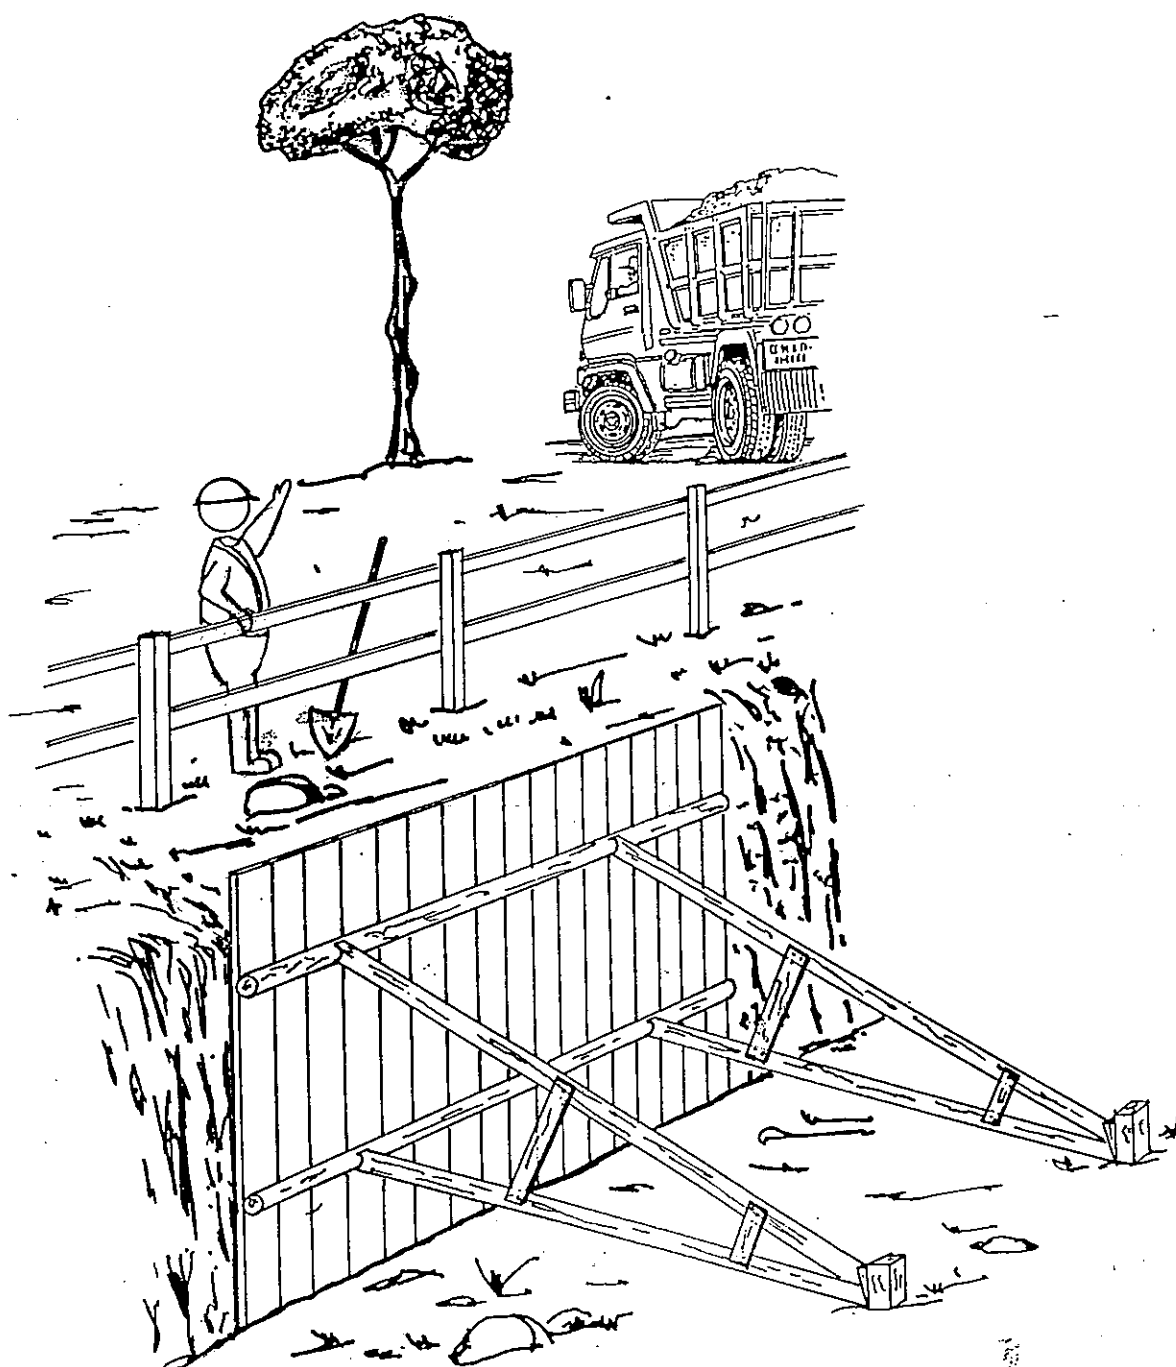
PARAPETTO BORDO SCAVO E ARMATURA CON TAVOLE VERTICALI
